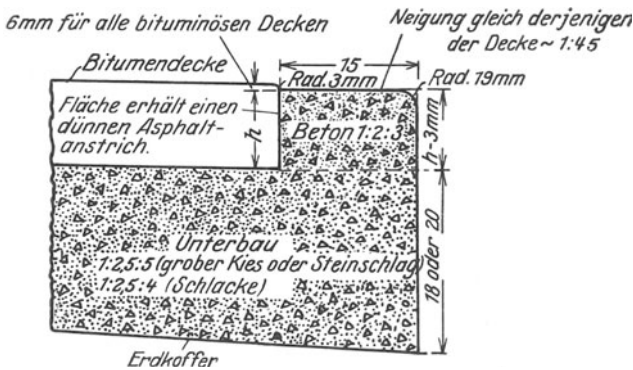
Asphaltfeinbeton auf Zementbetonunterlage.
